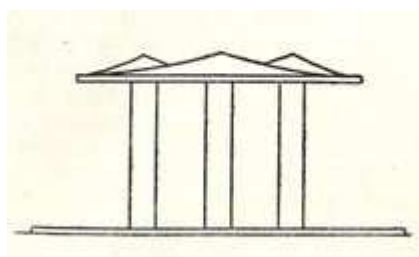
Круглое висячее покрытие павильона с тремя внутренними опорами. Фасад
